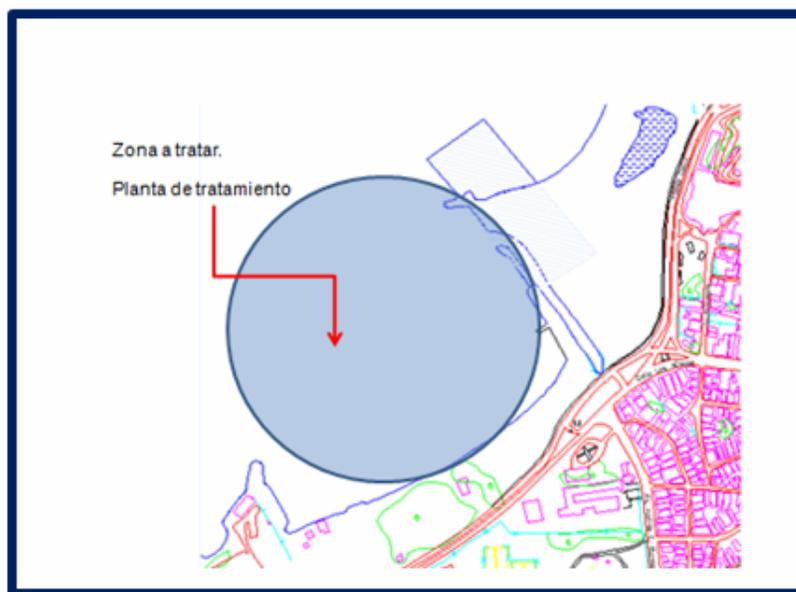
, plano ubicación, de la Planta de Tratamiento Fuente: Autor
